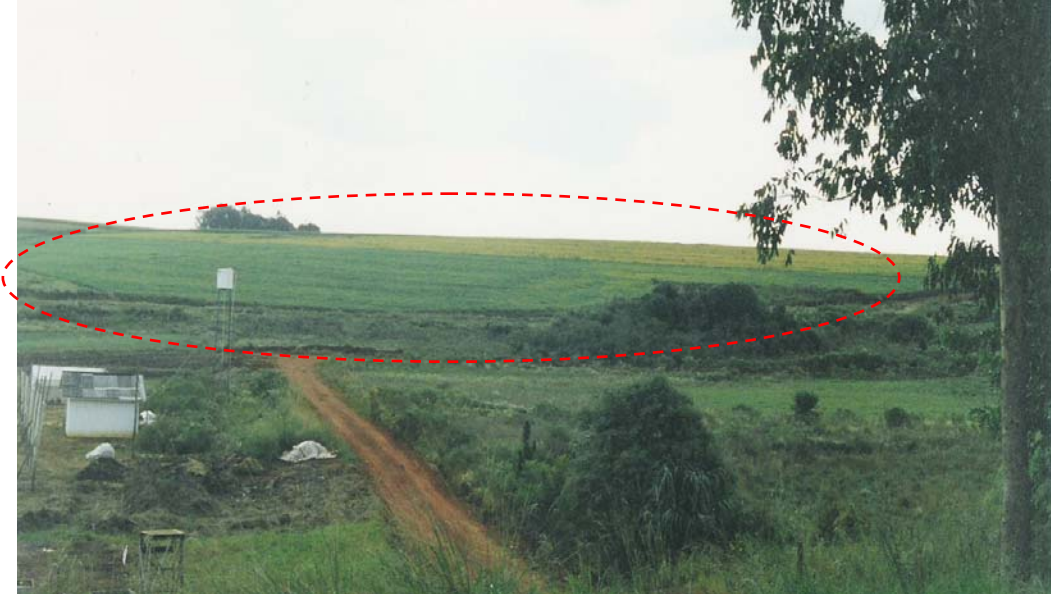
Vista do terreno destinado à implantação do CETEC-UPF.
